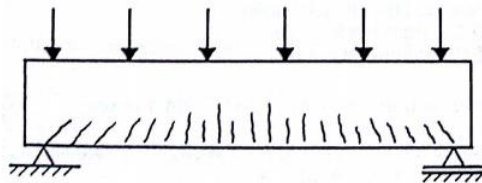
Fissuração típica em viga solicitada à flexão
